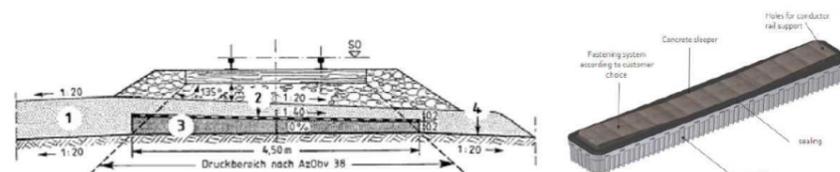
Exemples de poses antivibratiles. Gauche : dalle rigidifiante et tapis sous ballast. Droite : traverse monobloc dans un chausson (STEDEF monobloc).
